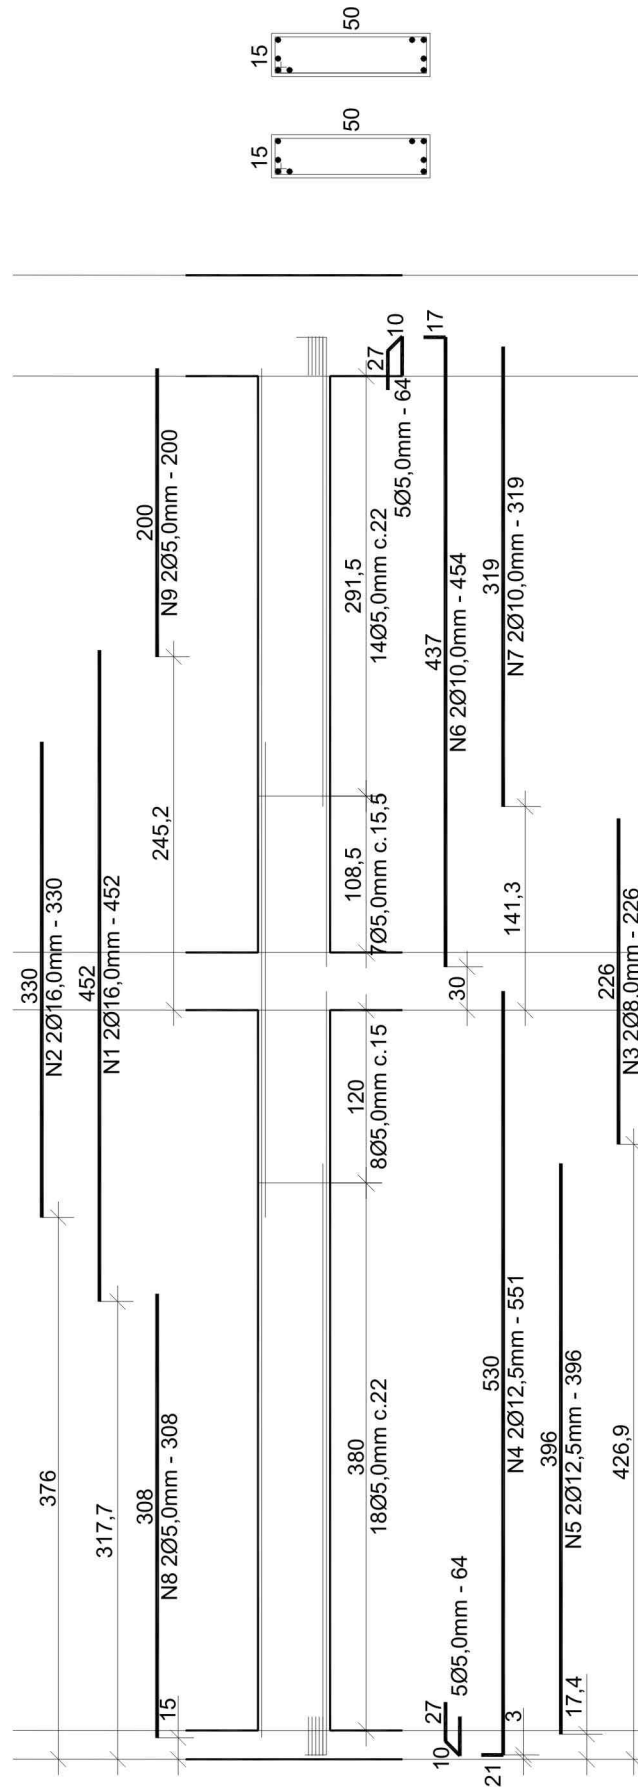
Detalhamento Viga 03.3, realizado pelo VigaCalc.
